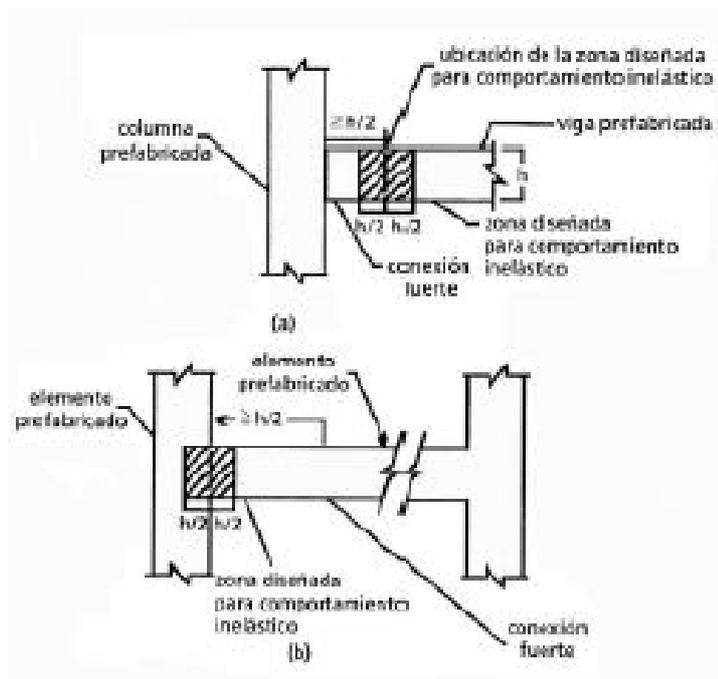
Comportamiento estructural en zonas sísmicas.
